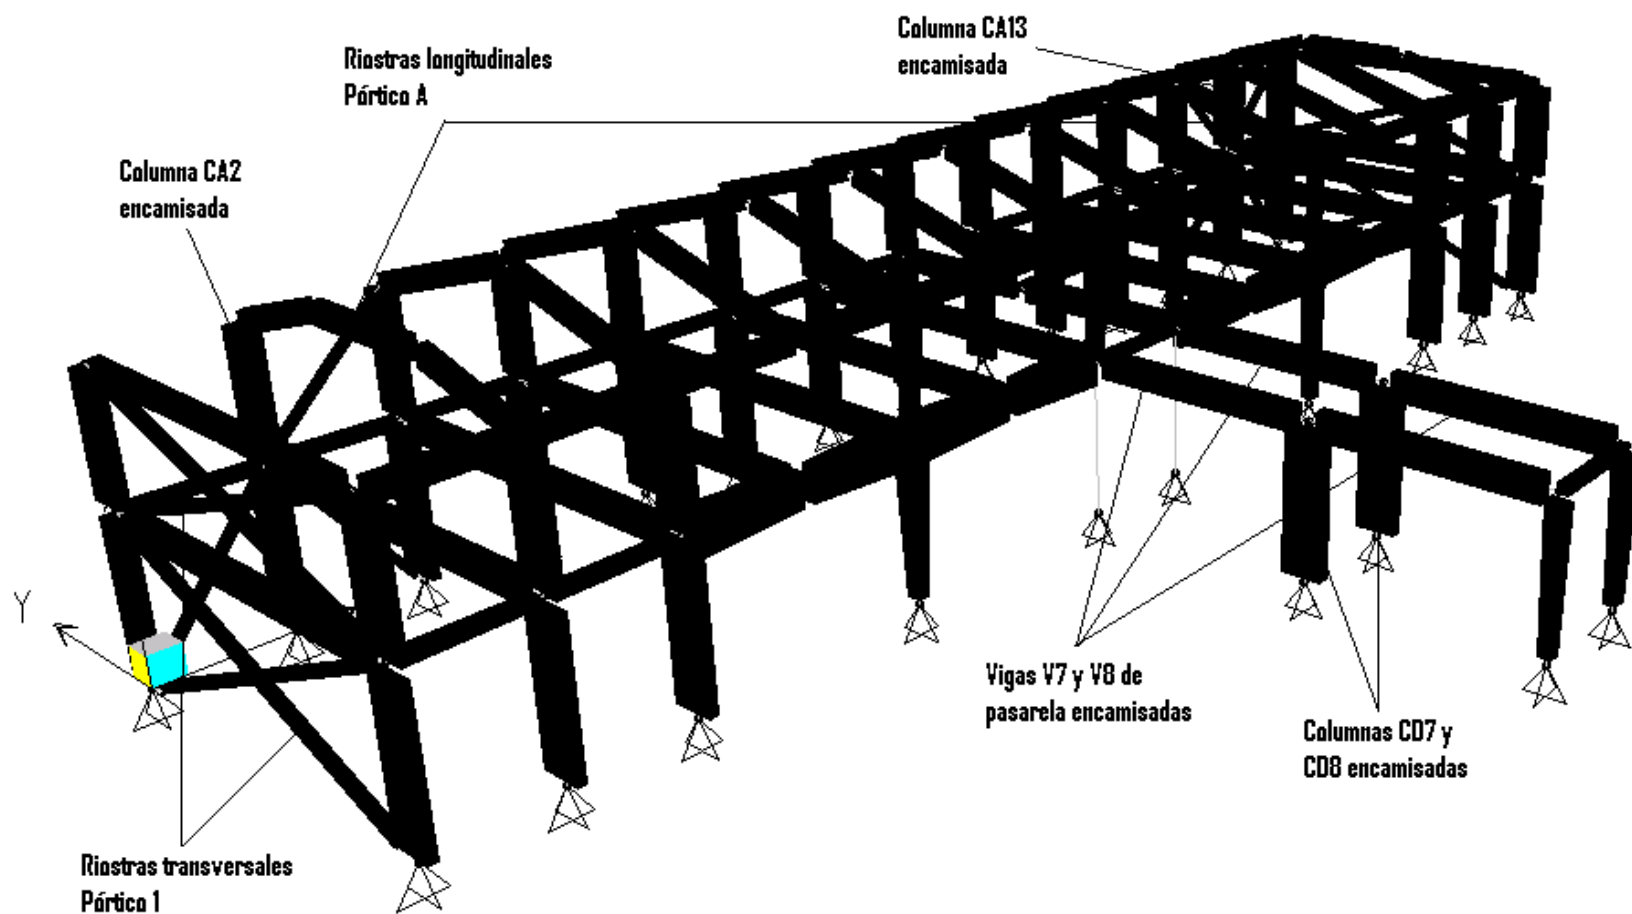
Pórtico de pasarela encamisado de vigas y columnas
